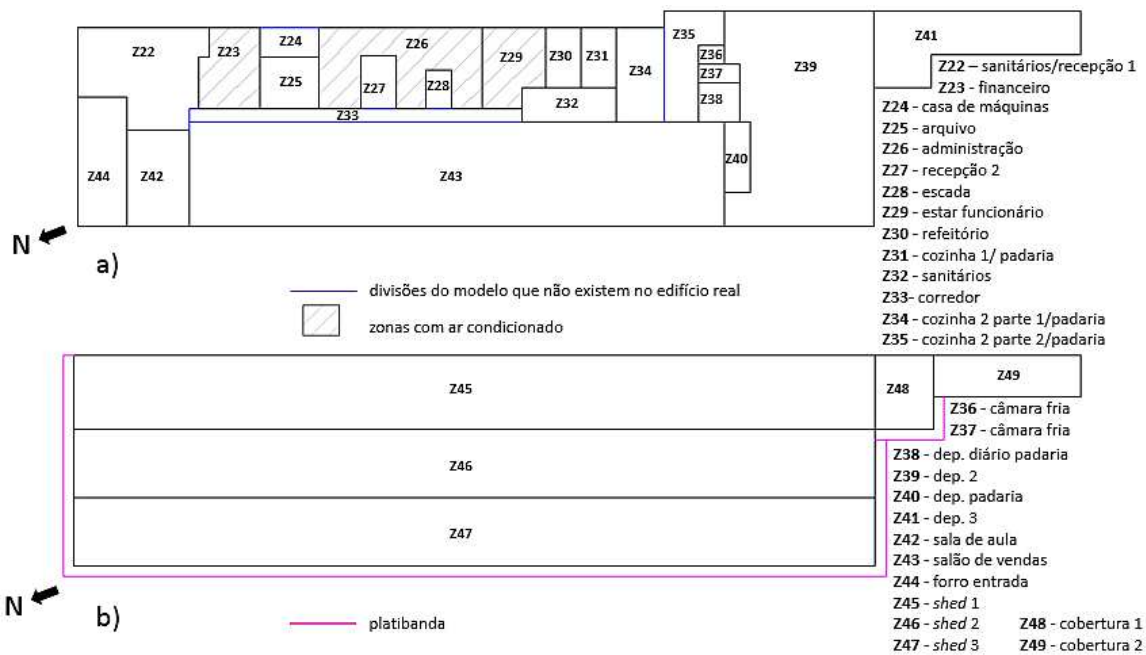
Zonas térmicas do Pavimento 1 e do ático do Supermercado escola: a) Pavimento 1 e b) ático
